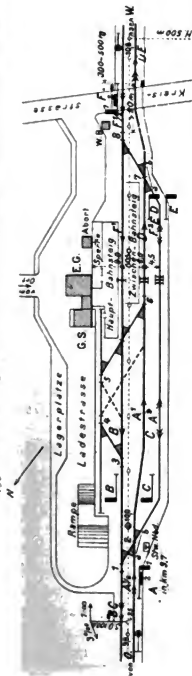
Nebenbahnhof bei beschränkter Entwicklungslänge.
